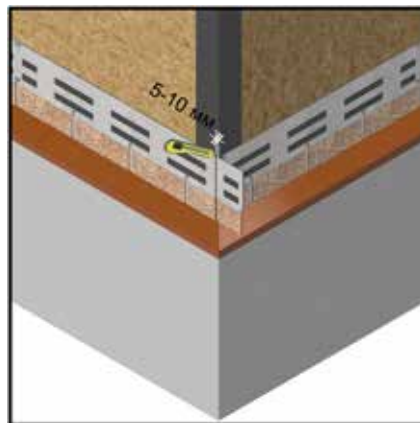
Подрезка фасадной плитки при подходе к углам.
